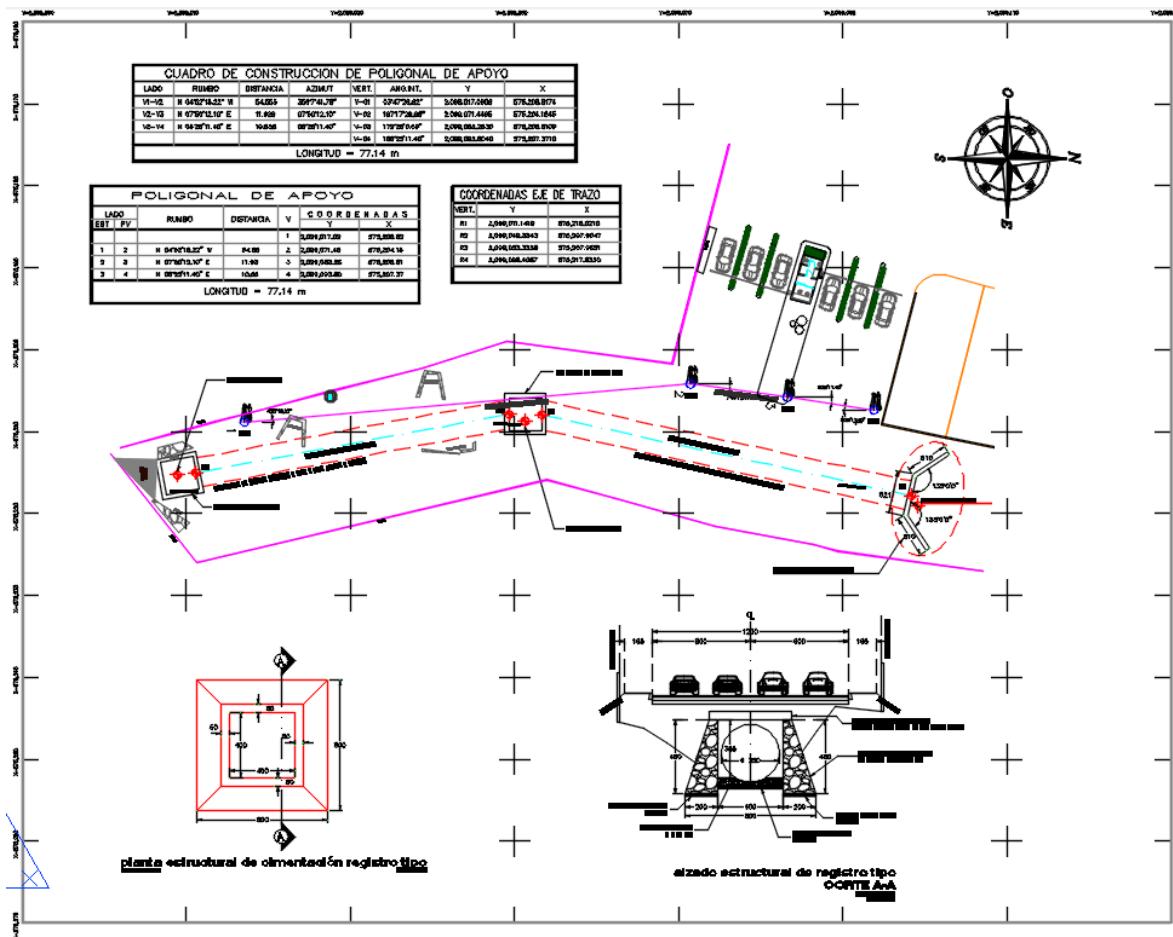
Plano de conjunto del proyecto del entubamiento del cauce de la Barranca Almoloya.
